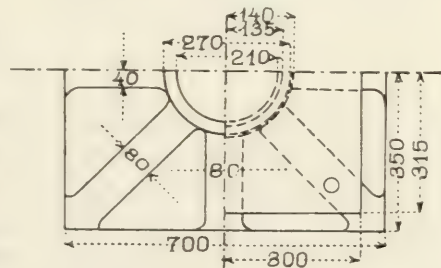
Lager einer unter 33° schiefen Eisenbahnbrücke von 40 m Stützweite.
